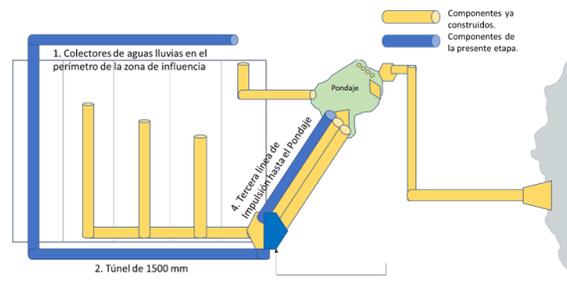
Esquema del componente alcantarillado pluvial SAI ETAPA 3.
